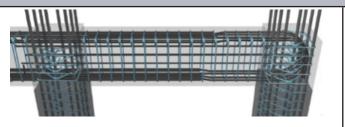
Armadura de acero en vigas y columnas http://civilgeekscom/2014/01/19/comportamiento-y-diseno-de-nudos-de-concreto-armado,
